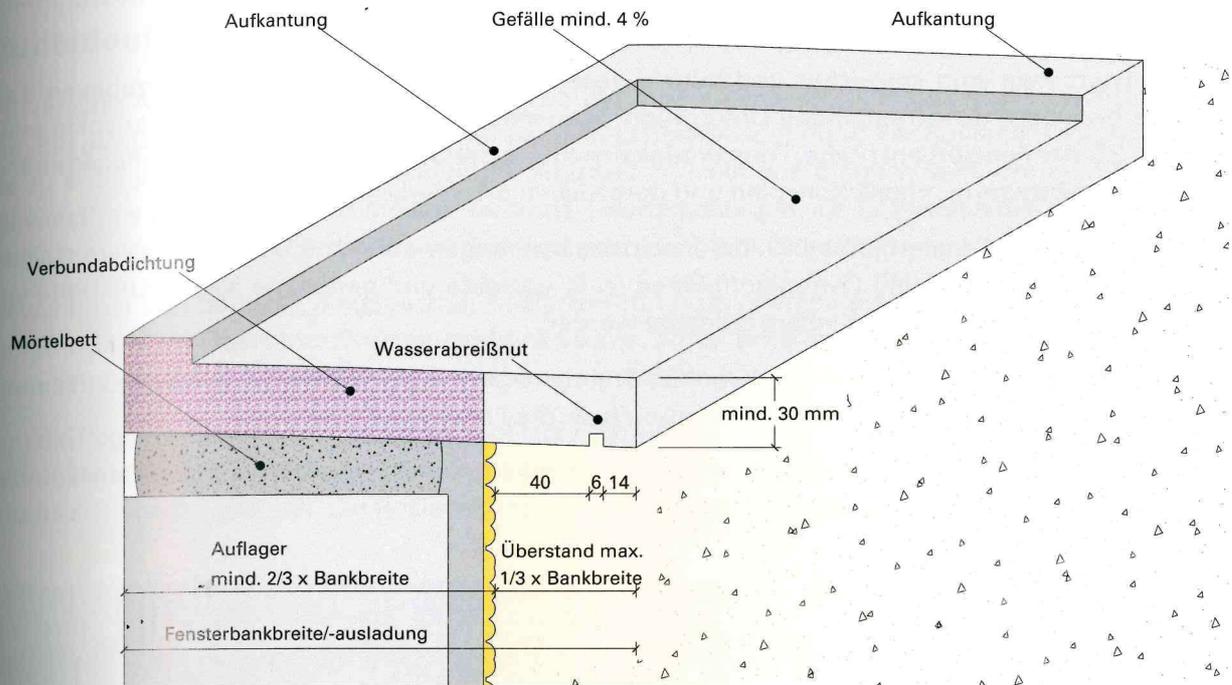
Skizze einer Werksteinfensterbank mit seitlicher und hinterer Aufkantung
